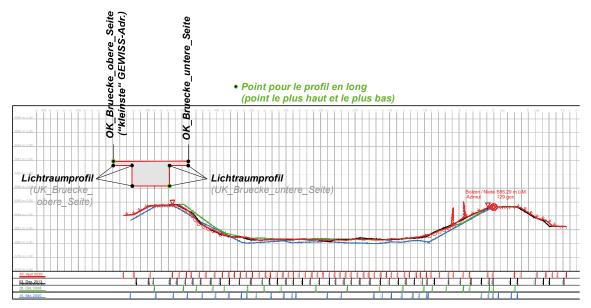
Exemple de profil en coupe, profil en travers GEWISS_Adr. 218487
